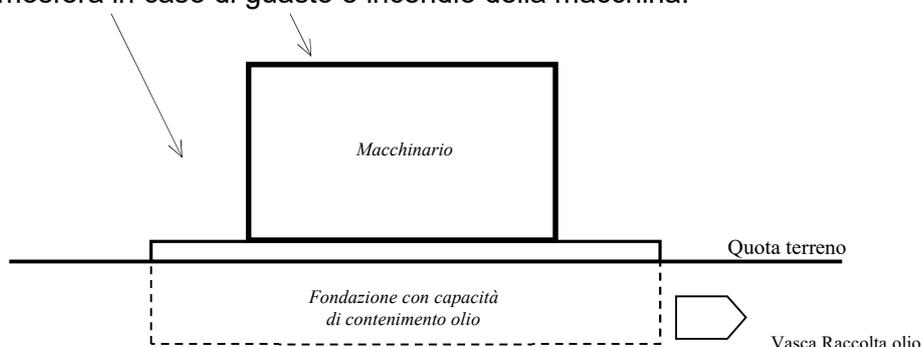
/1 - Rappresentazione schematica del sistema Vasca-Fondazione
